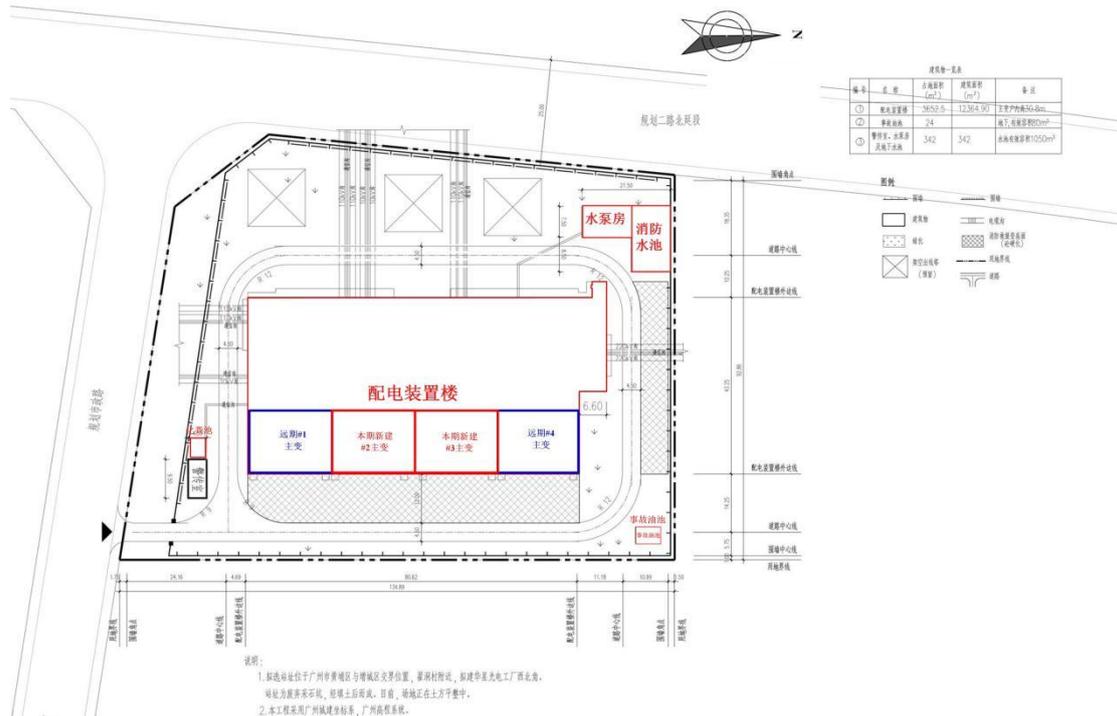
220kV 集丰（翟洞）变电站总平面布置图
